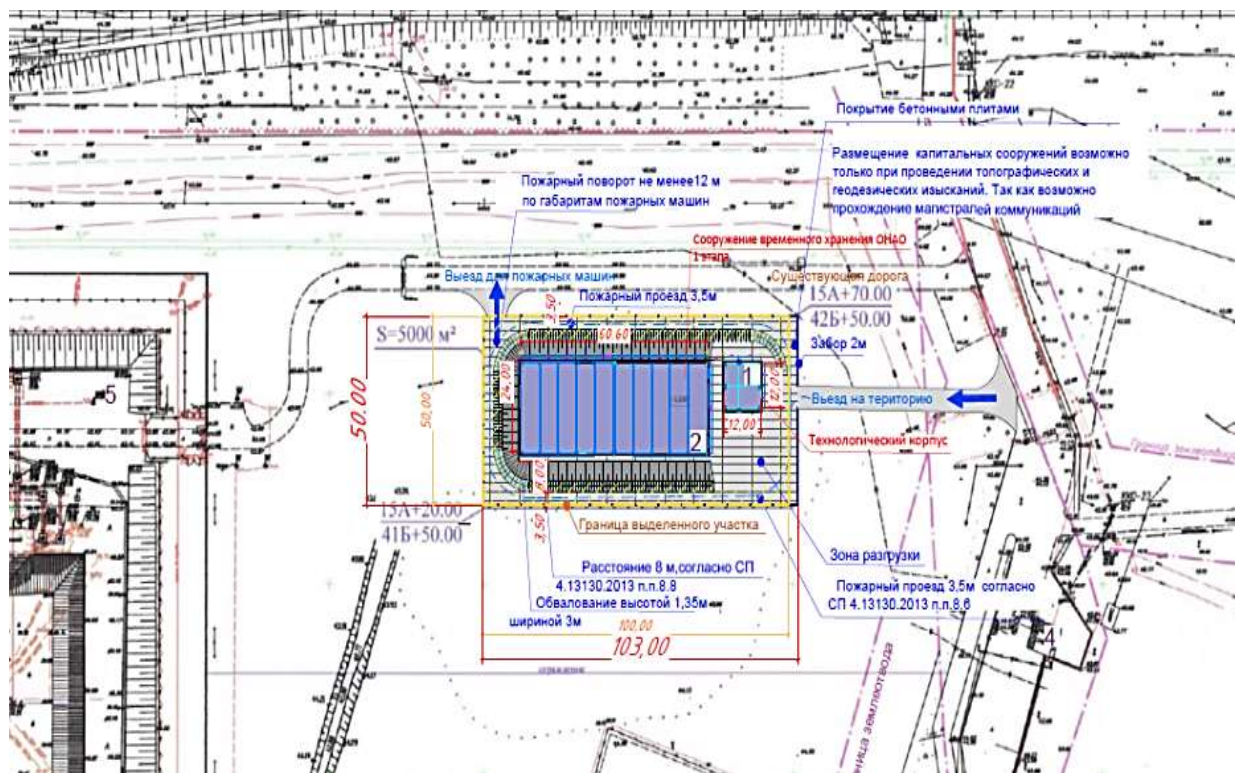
План размещения ПЗ ОНАО [Disposal site plan for very low level waste]
